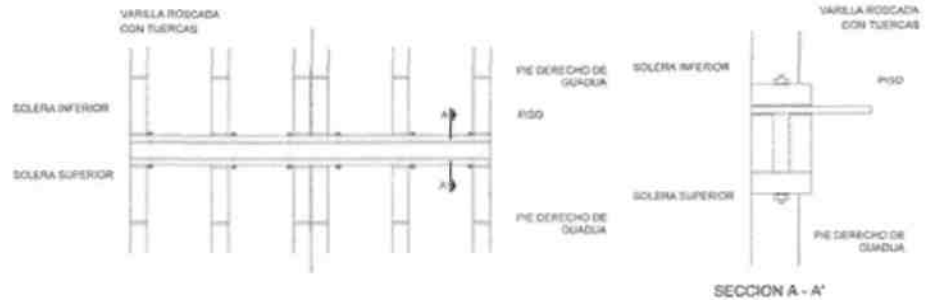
Unión muros primer piso con muros del segundo piso.
